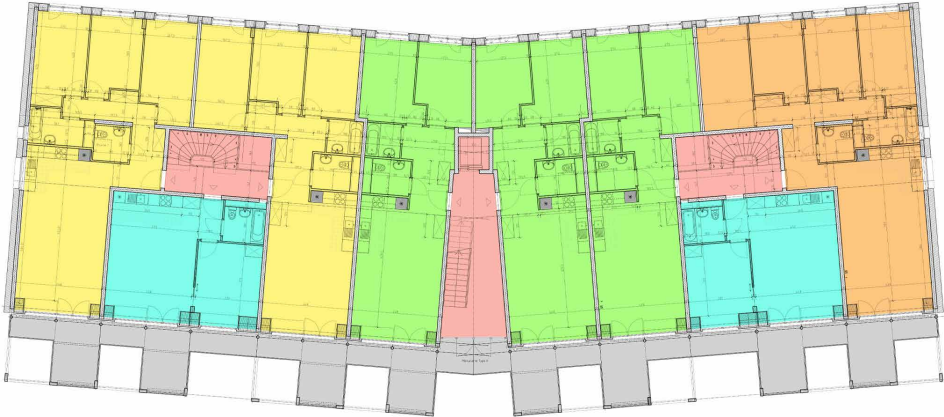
d. Plan d'un étage type. Source de l'image de fond : Coopérative équilibre
